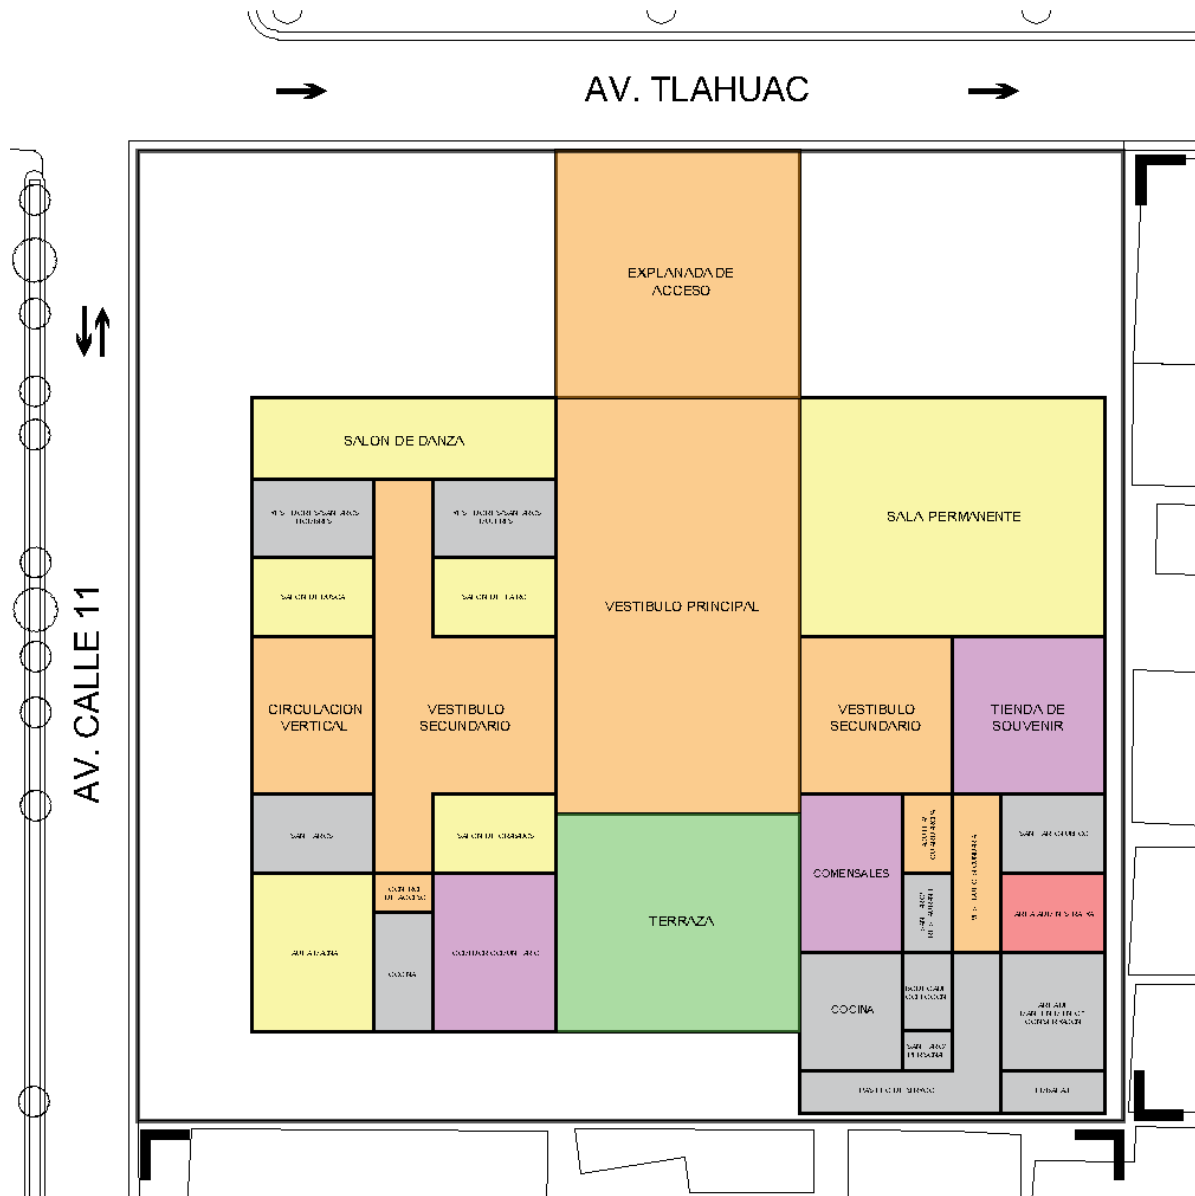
Zonificación desarrollada del plan maestro en planta baja en terreno seleccionado, respetando la normatividad vigente. Elaboración propia.
